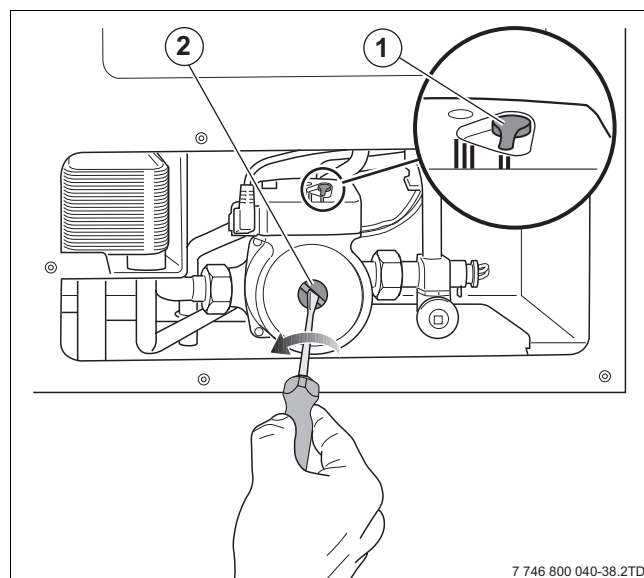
Удаление воздуха из загрузочного насоса бака-водонагревателя
